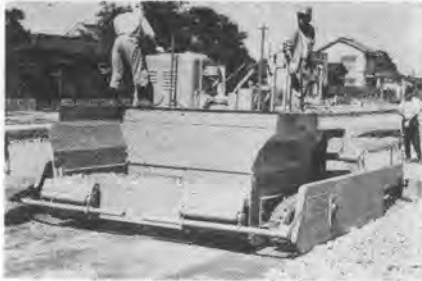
西宮成舗装（直営）施工中のアグリゲートスプレッダ
